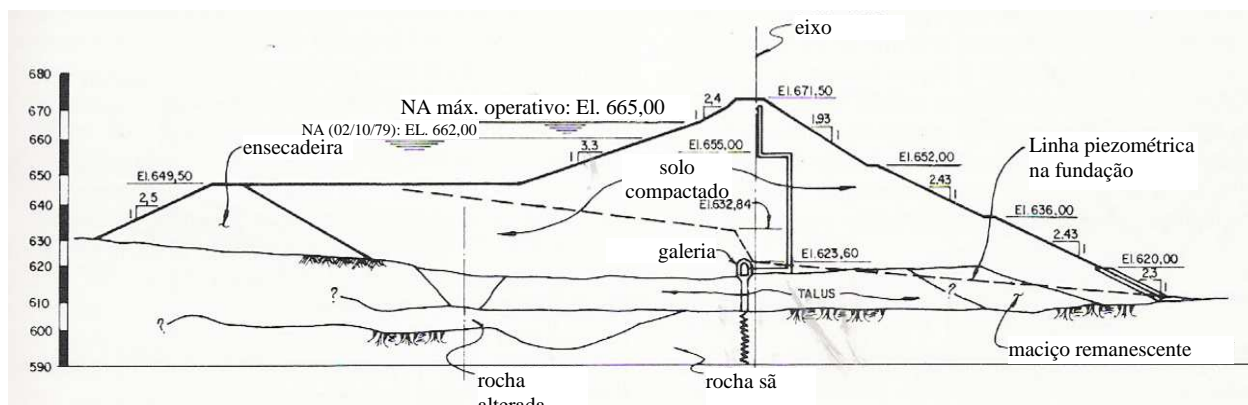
Corte longitudinal da barragem na seção de ruptura.
